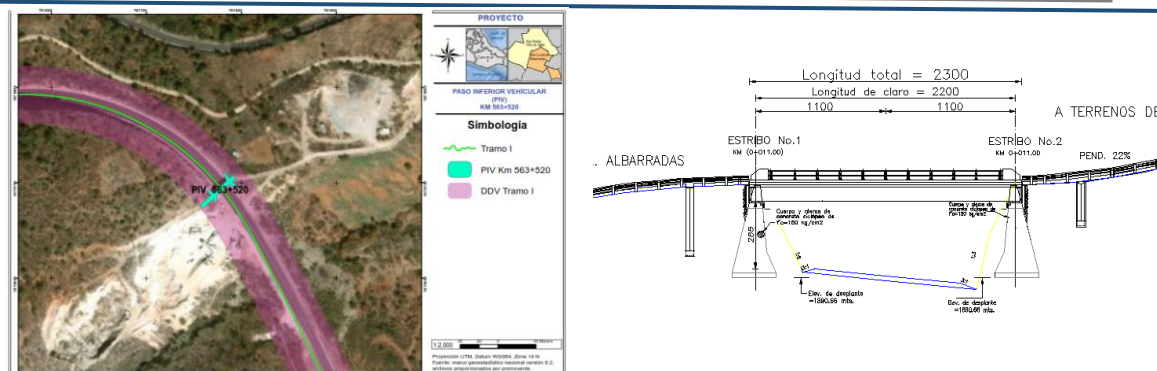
Proyecto en planta y perfil longitudinal del PIV 563+520.
